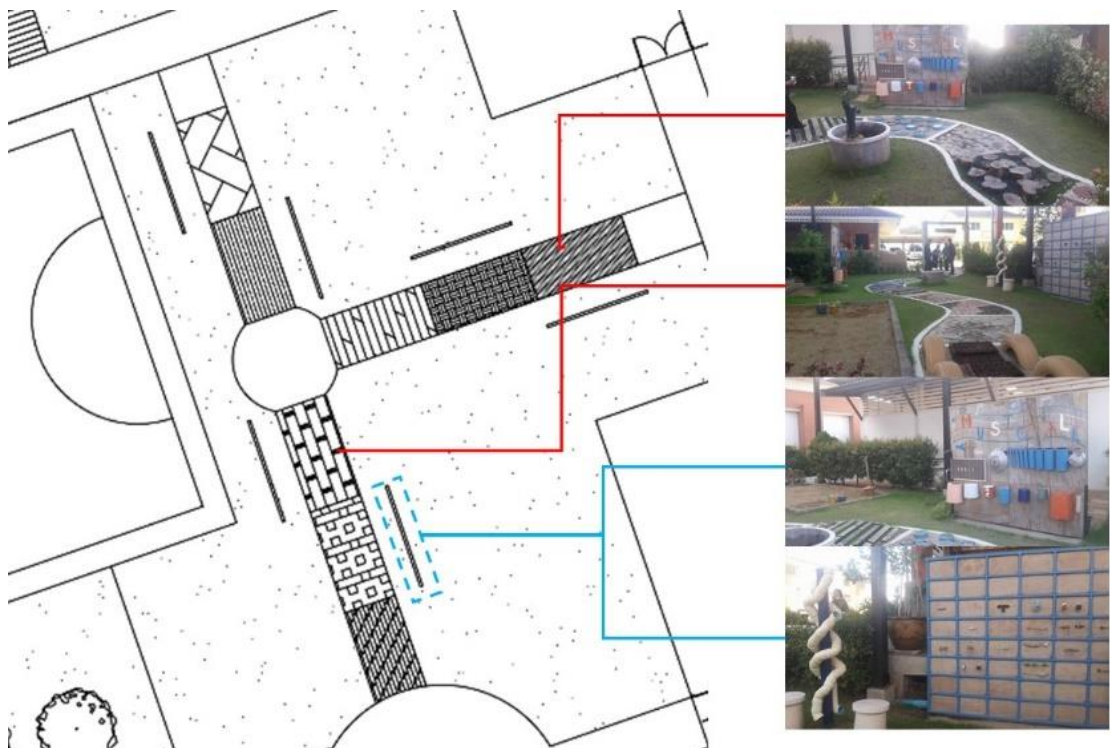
Schematic Plan (Ground Floor Plan)
